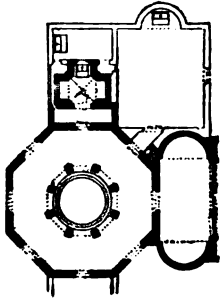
Grundriss des Baptisteriums des Lateran in Rom.
